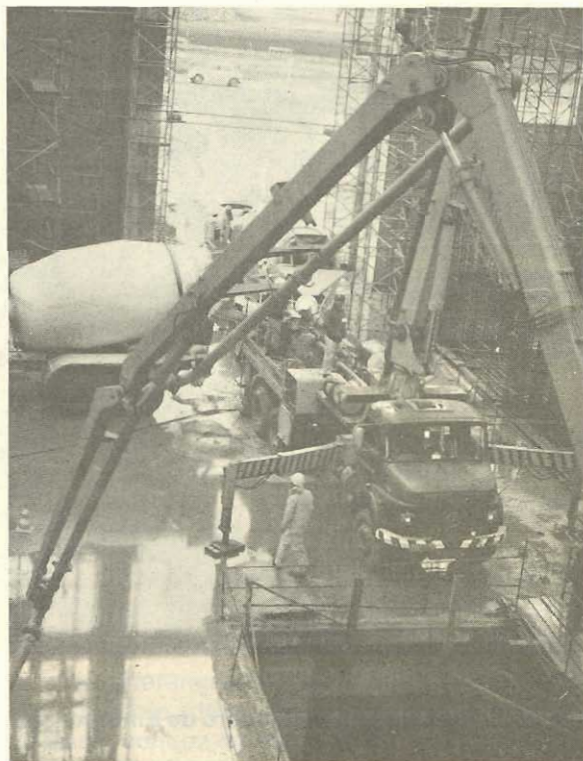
Aplicação de concreto por bombas acopladas às alavancas móveis articuladas - Jacuí
